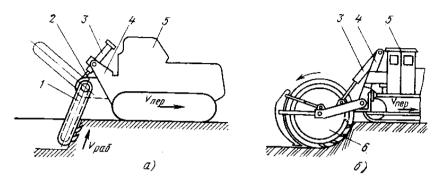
Машины для нарезания щелей в мерзлых грунтах: а – баровая машина; б – дискофрезерная машина; 1 – бар; 2 – трансмиссия; 3 – гидроцилиндр; 4 – кронштейны подвески; 5 – базовый трактор; 6 – фреза
